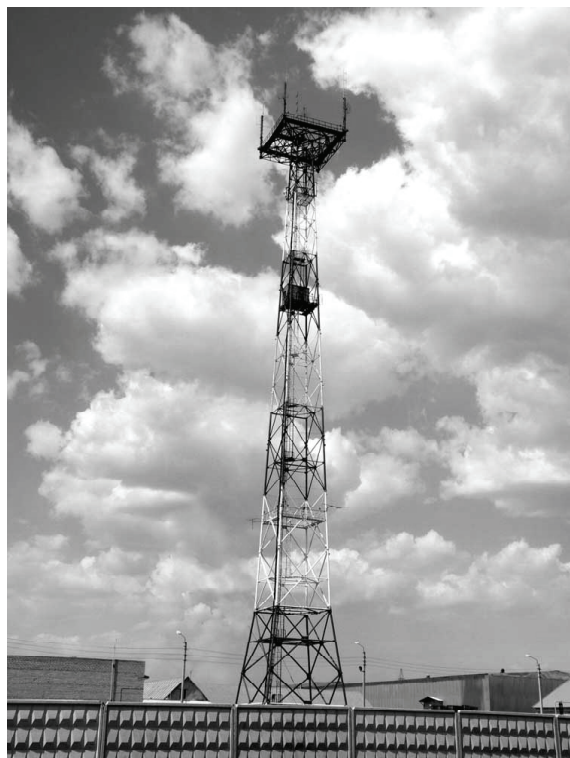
Общий вид решетчатой башни трубчатого сечения.
